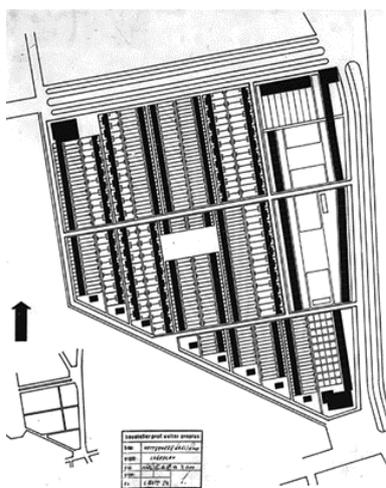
Dammerstock в Берлине [3] и SiemensStadt в Карлсруэ [5]
